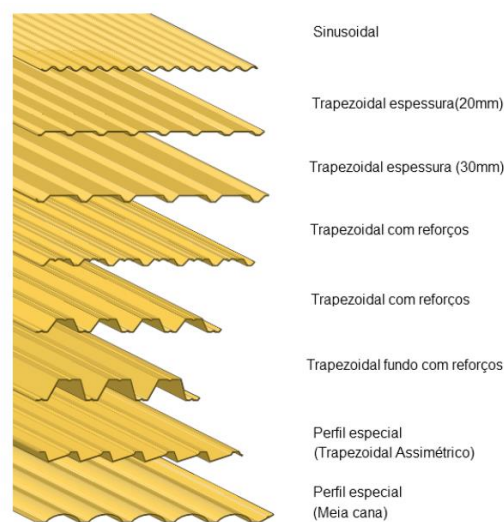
Exemplos de diferentes tipos de chapa metálica para revestimento de fachadas (adaptado de ArceloMittal)
